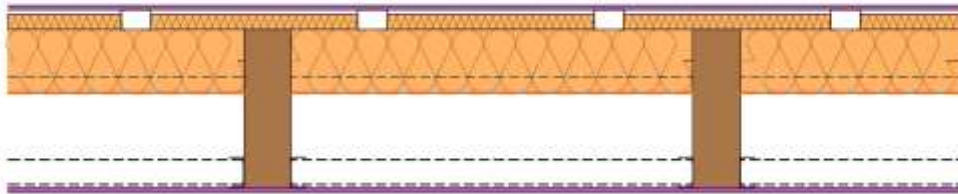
particolare della struttura pareti fronti nord e sud della palestra
